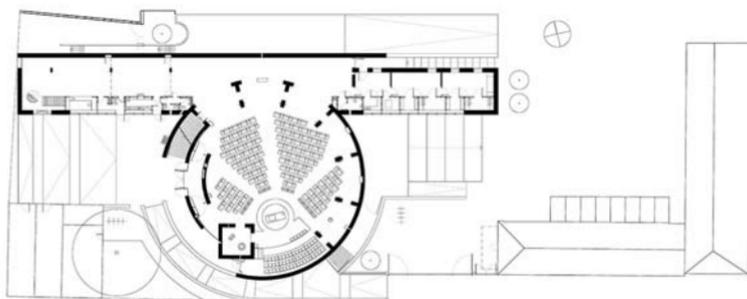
Grundriss von St. Theodor in Köln-Vingst.
